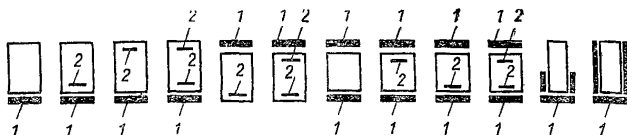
Виды продольного армирования элементов с внешней арматурой (прямоугольное сечение показано условно)
